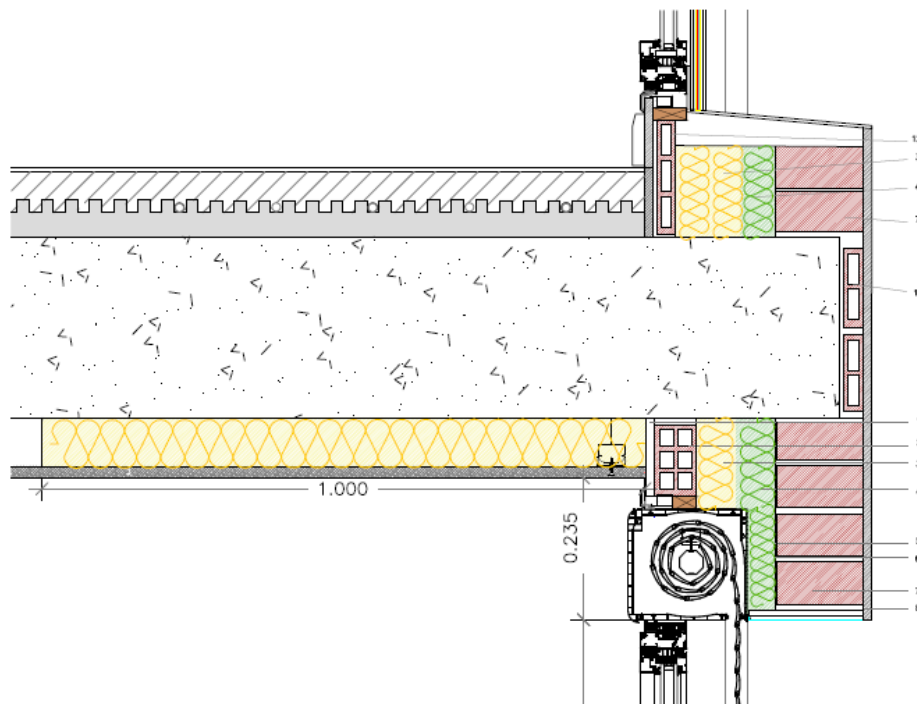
Sección constructiva, corte vertical, de la propuesta de fachada tradicional a estudio.
